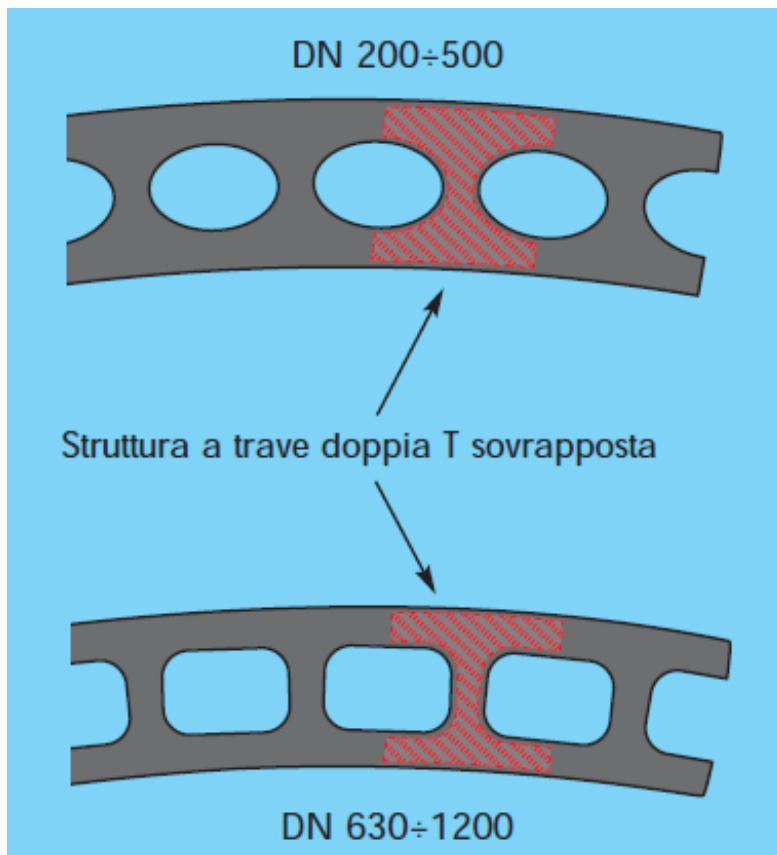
Sezioni trasversali tipiche dei tubi a parete strutturata tipo AlveHol.
